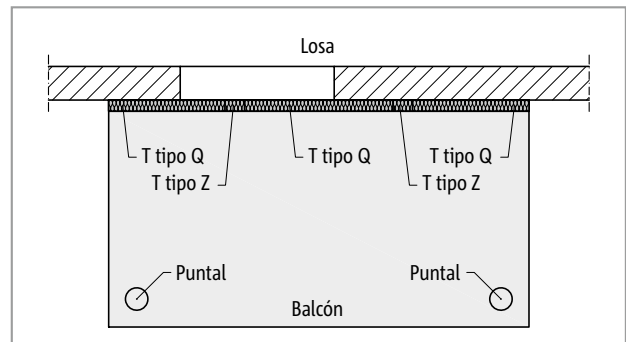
Schöck Isokorb® T tipo Z, K: Balcón apoyado en puntales
